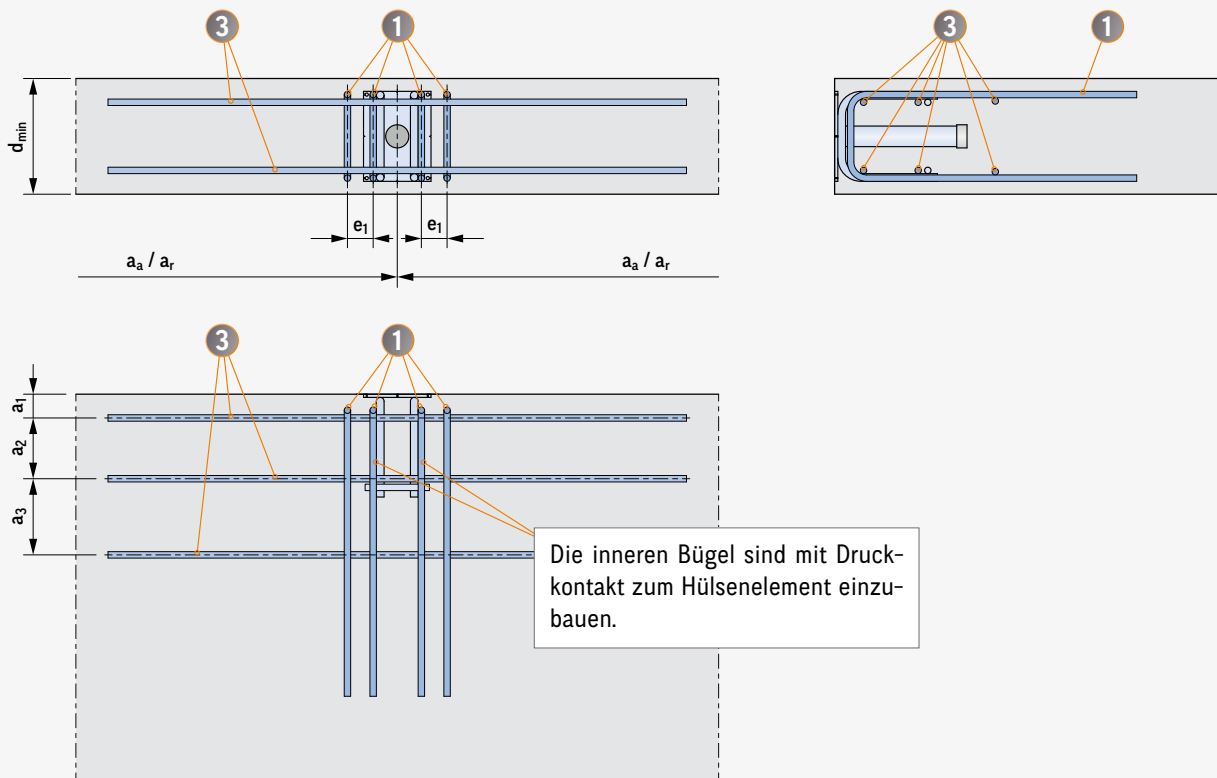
Bewehrung bei Einbau in Bauteilmitte
